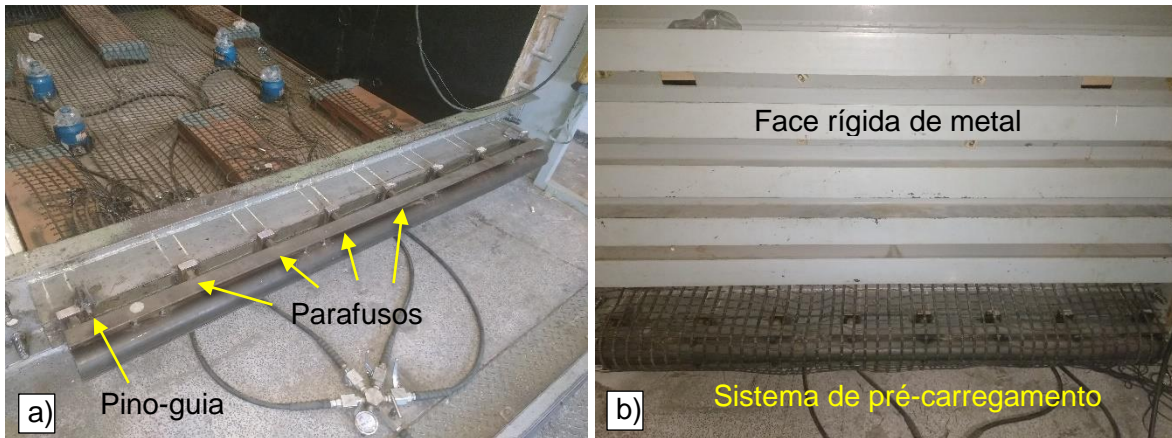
Detalhes da montagem do modelo físico: a) sistema de pré-carregamento; b) sistema finalizado e face rígida de metal instalada.
